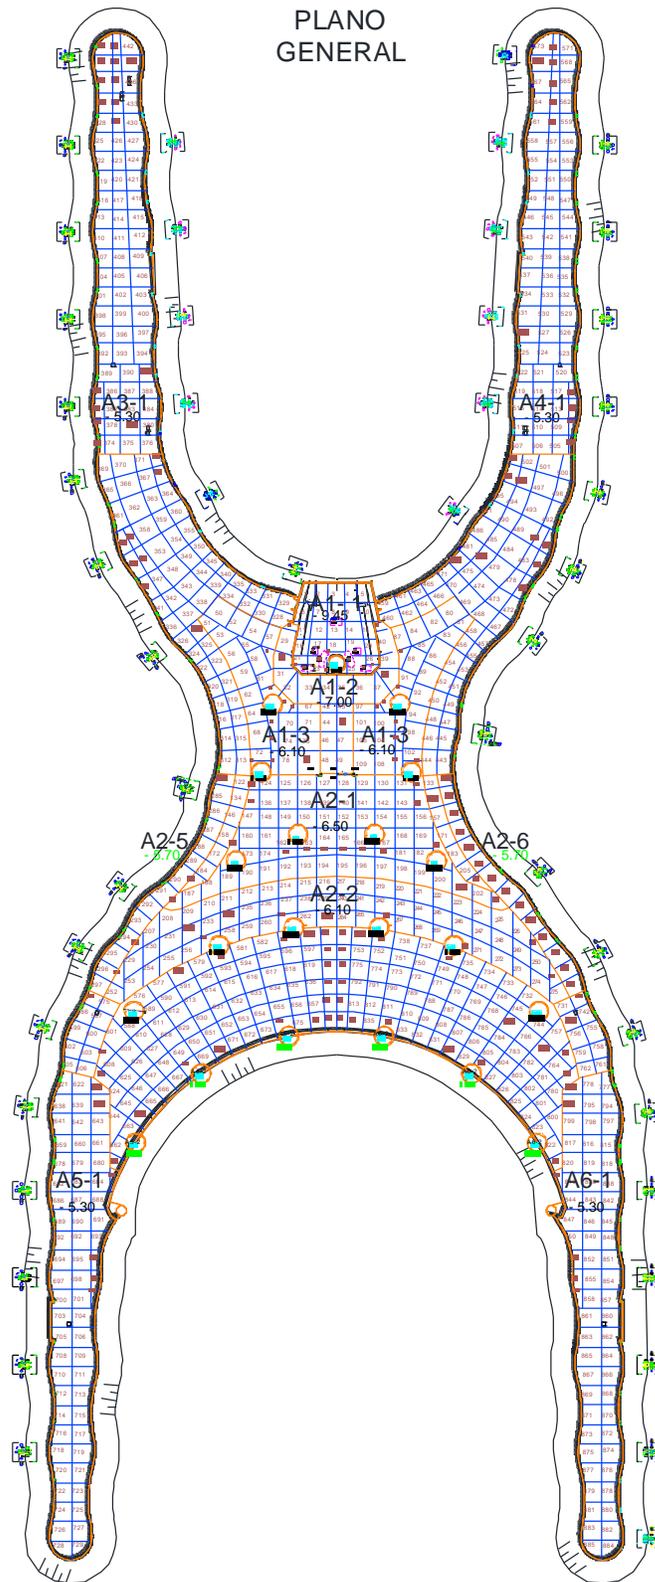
, Plan Maestro Del NAICM y su ubicación durante la Primera Fase
